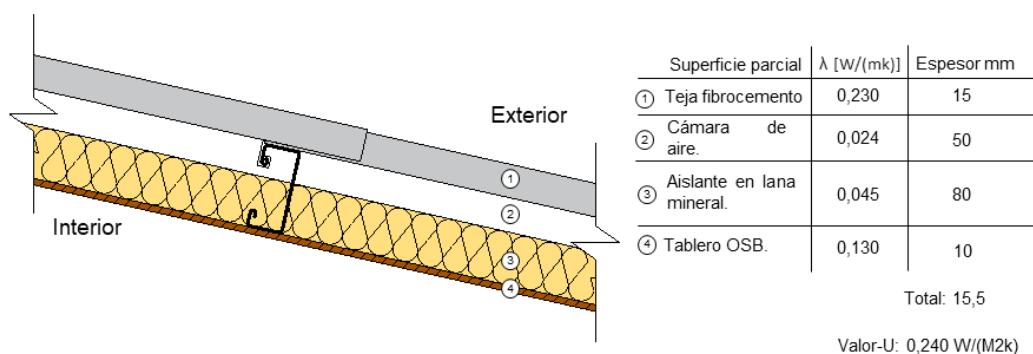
Detalle de solución constructiva para cubierta. Fuente: elaboración propia.
